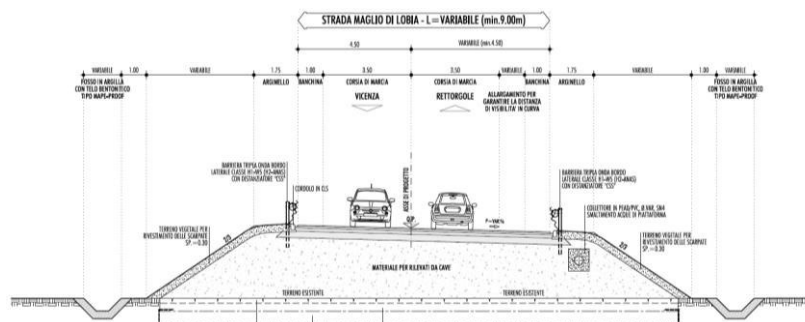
SEZIONE TIPO IN RILEVATO DELL'ASSE SECONDARIO
